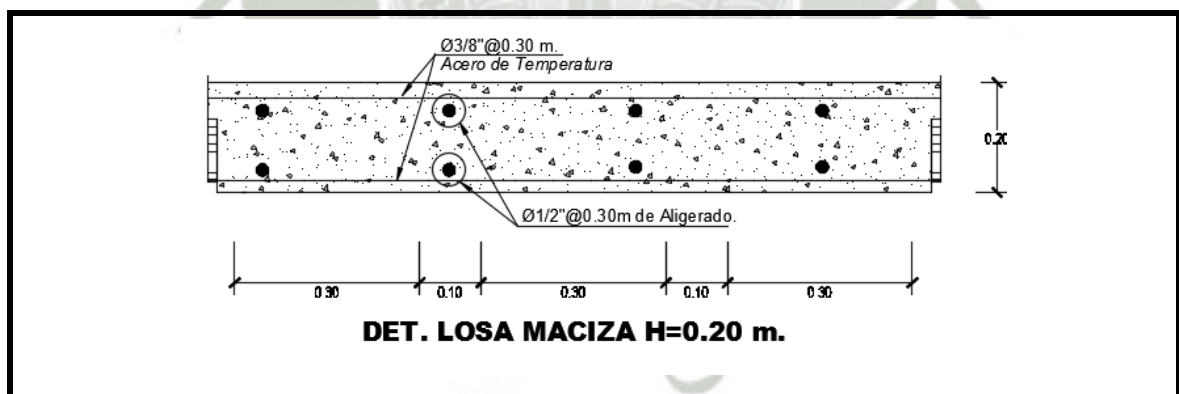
B: Sección de Losa Maciza h=0.20m.
